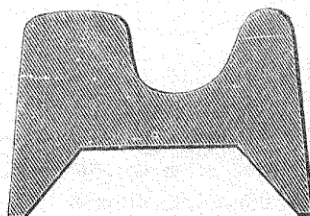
Section du rail de Loubat. 19 kil. par mètre courant. Échelle 1/2.
